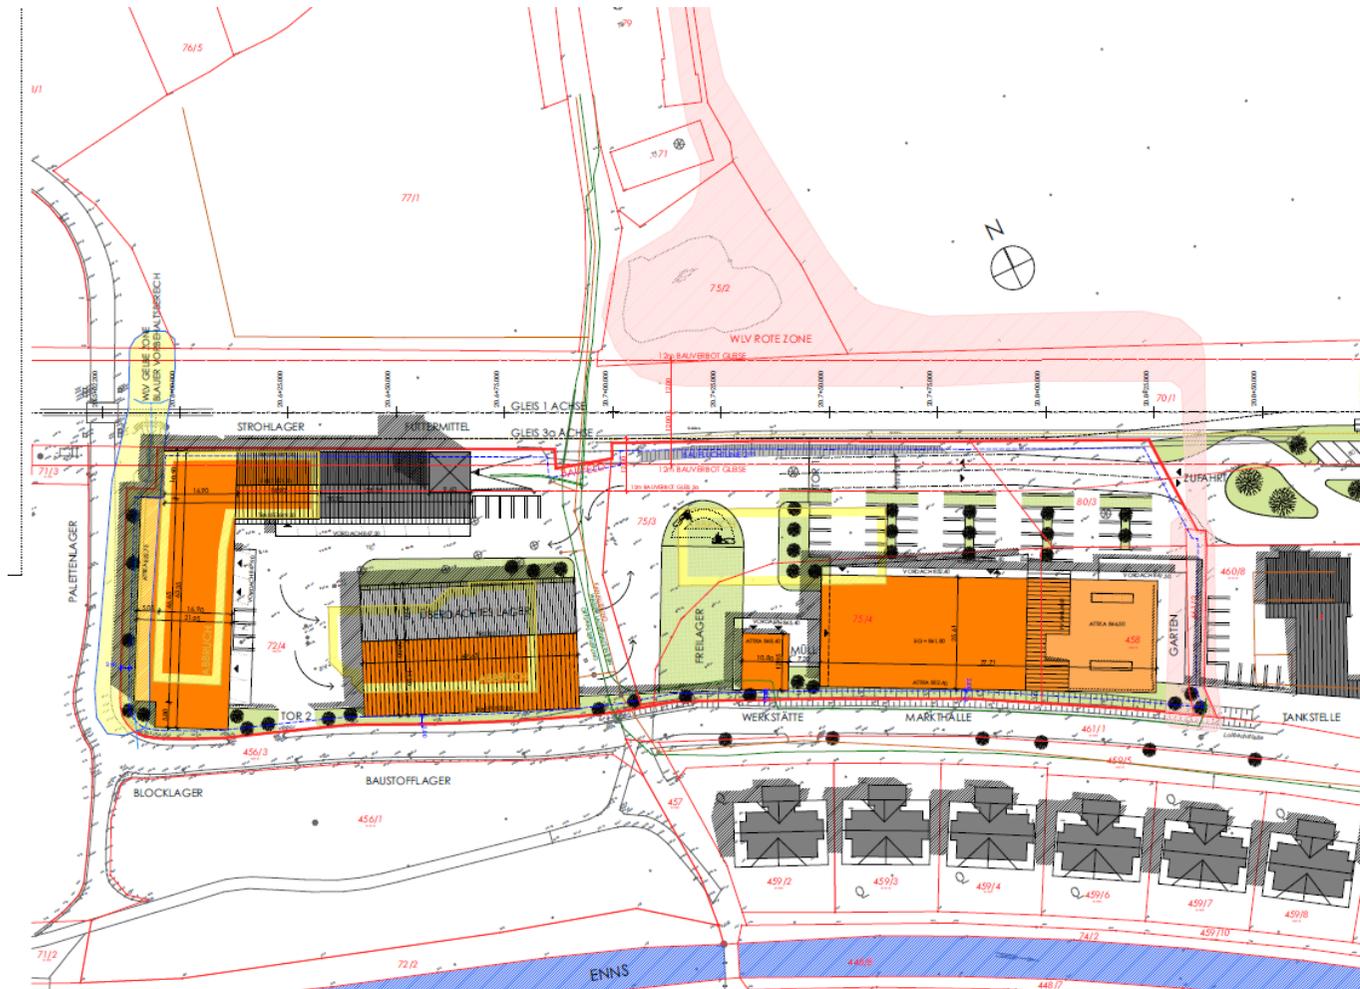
Situationsplan Erweiterung Lagerhaus Oberes Ennstal, Gelb-Abbruch.
